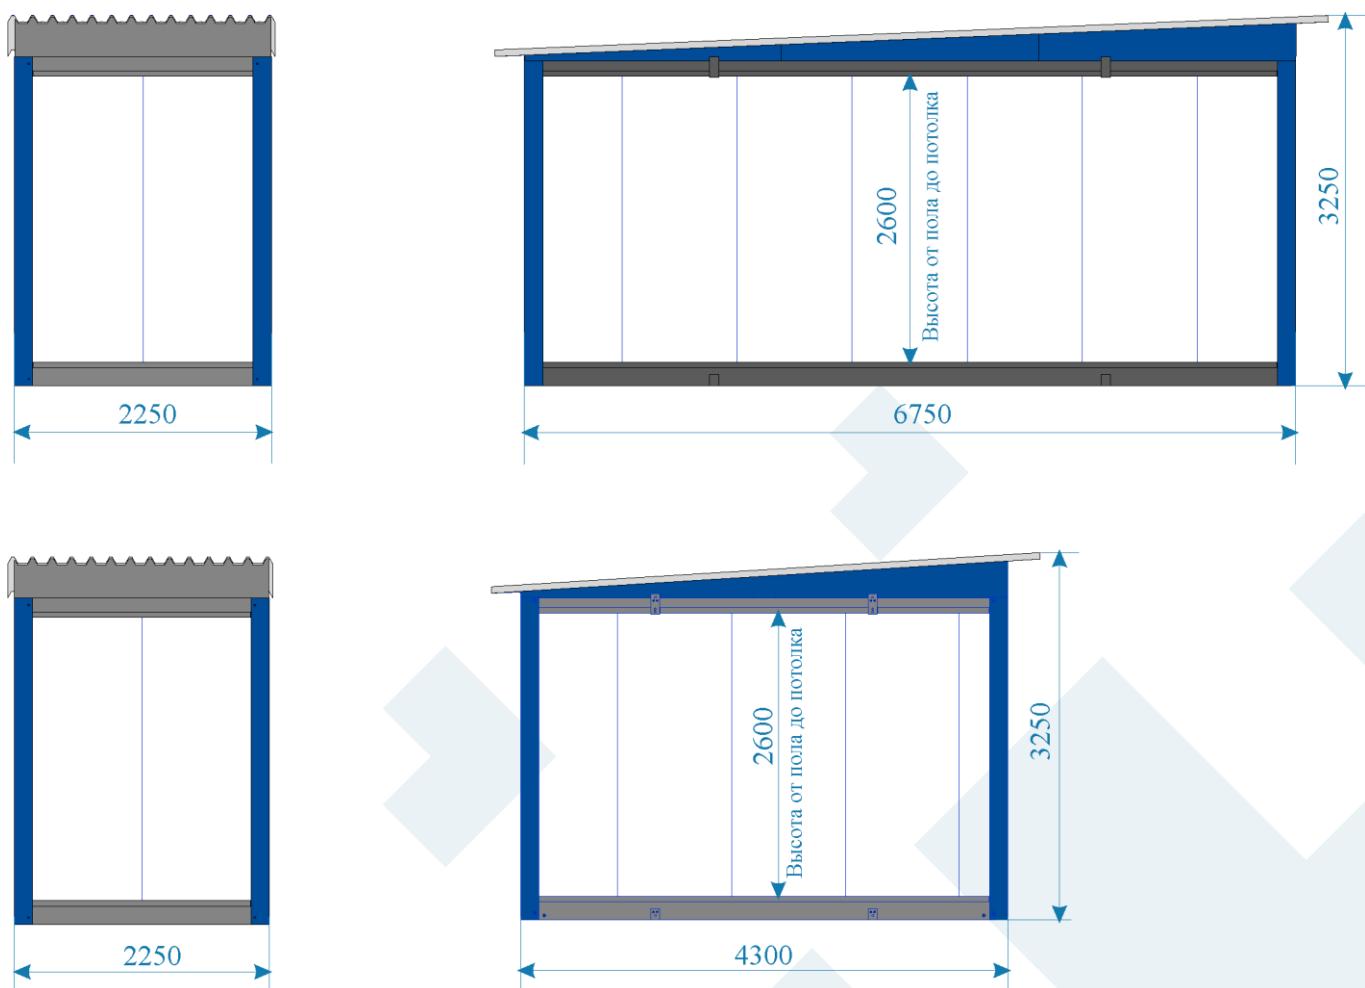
Габаритные размеры стандартного модуля и модуля с шириной 4300 мм
